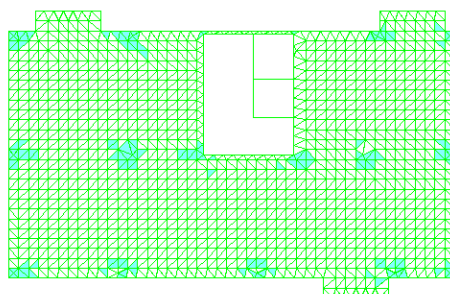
Площа поперечної арматури вздовж вісі X
